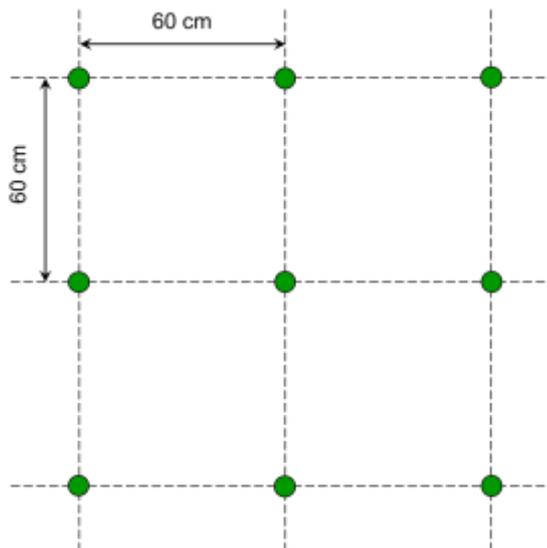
Plan de chevillage complémentaire après marouflage de l'armature.
